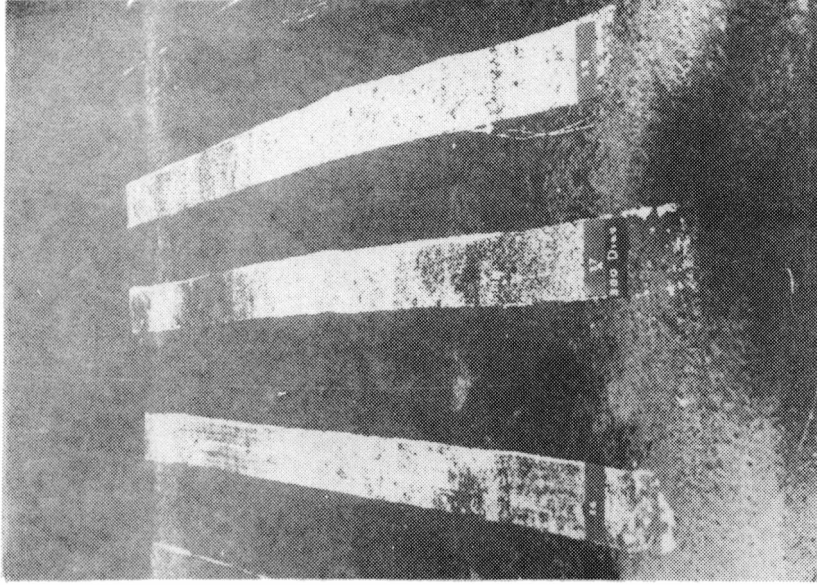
Muestras 16, 17 y 18, 300 días sobre pavimento asfáltico
